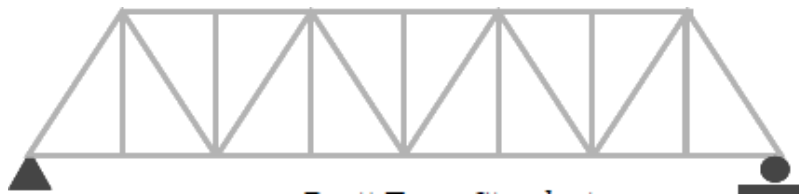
Jembatan Rangka Tipe *Petit Truss/Pennsylvania Truss
